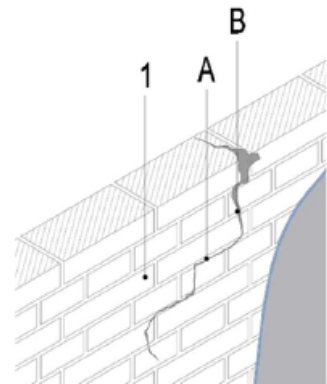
Detalle constructivo de solución de reparación relleno de fisuras y grietas – Fuente: Denisse & González Tardón, n.d.
